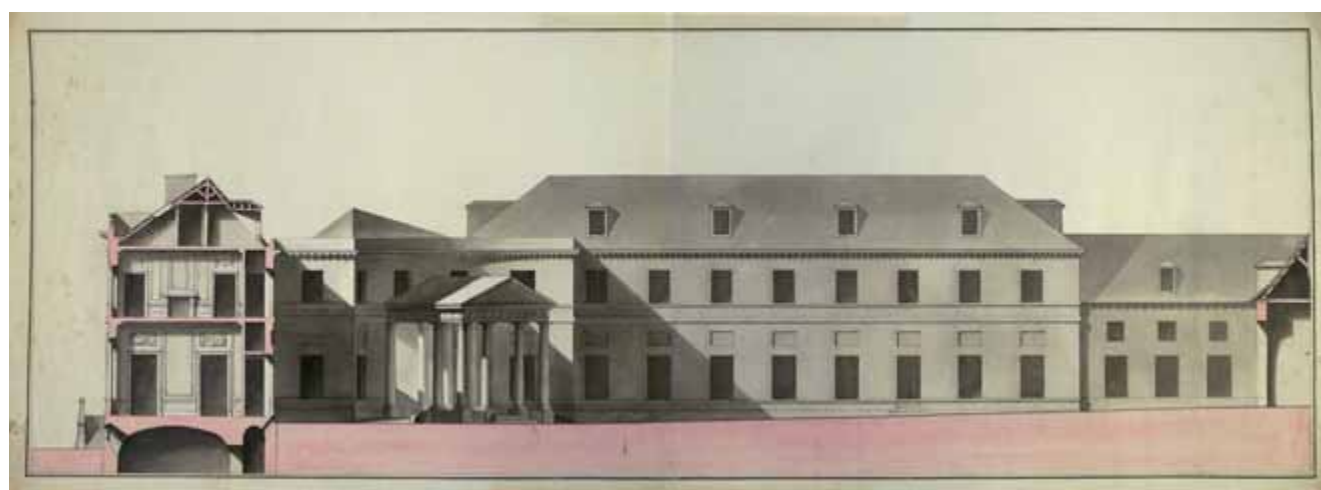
Projet de château d'Enghien à la Cense, coupe et élévation sur la cour (Archives Générales du Royaume).
